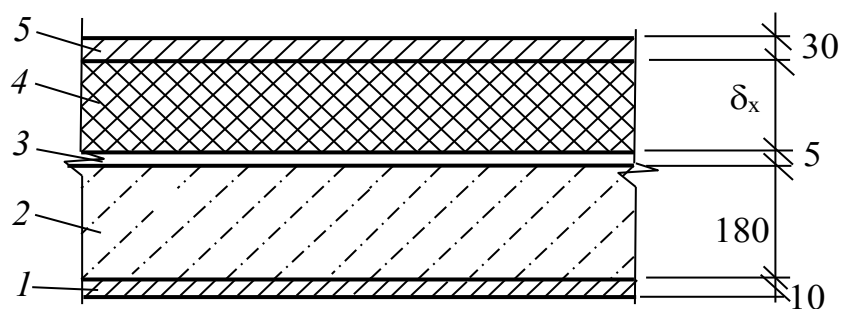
Вариант 1 конструкции чердачного перекрытия:
